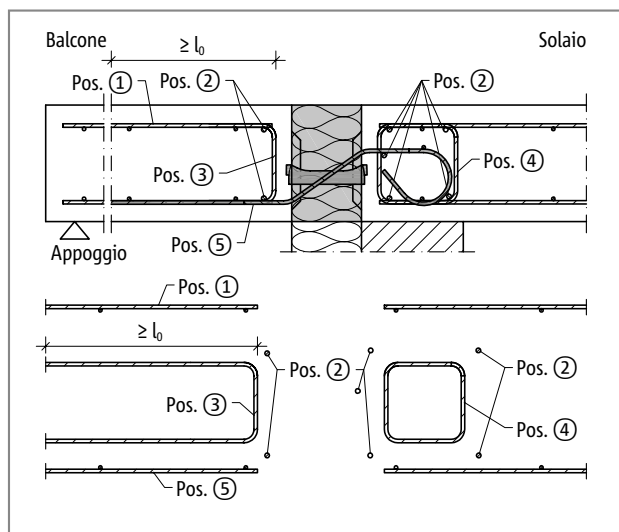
Schöck Isokorb® tipo da QXT10 a QXT40: armatura in opera
